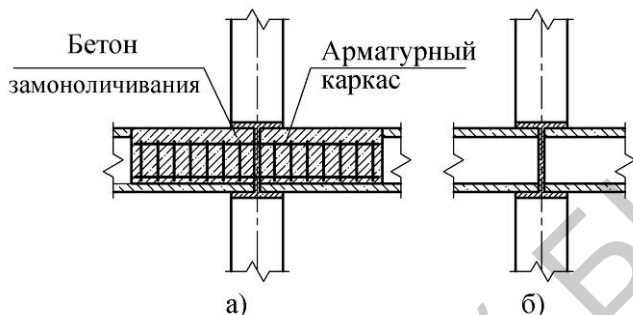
Неразрезная (а) и разрезная (б) схема опирания плит перекрытия
